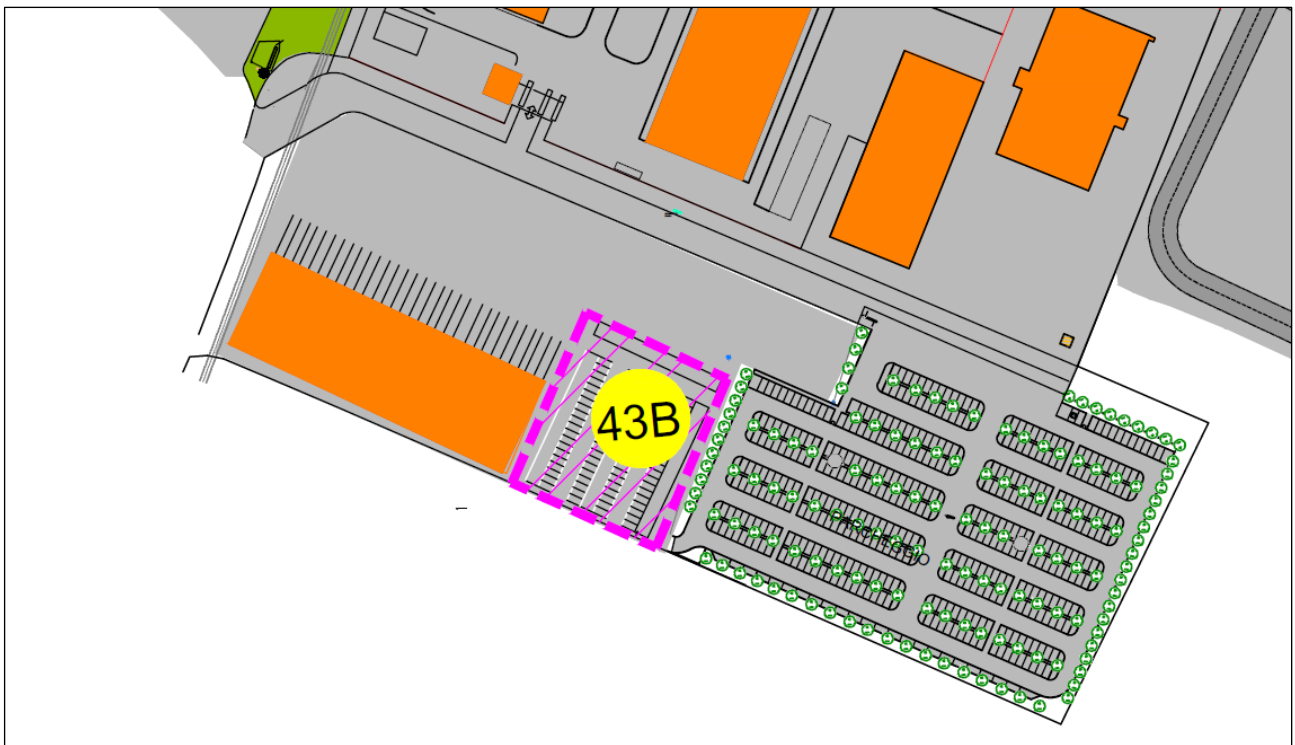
Estratto Master Plan – Parcheggi e Viabilità Area Spedizionieri
